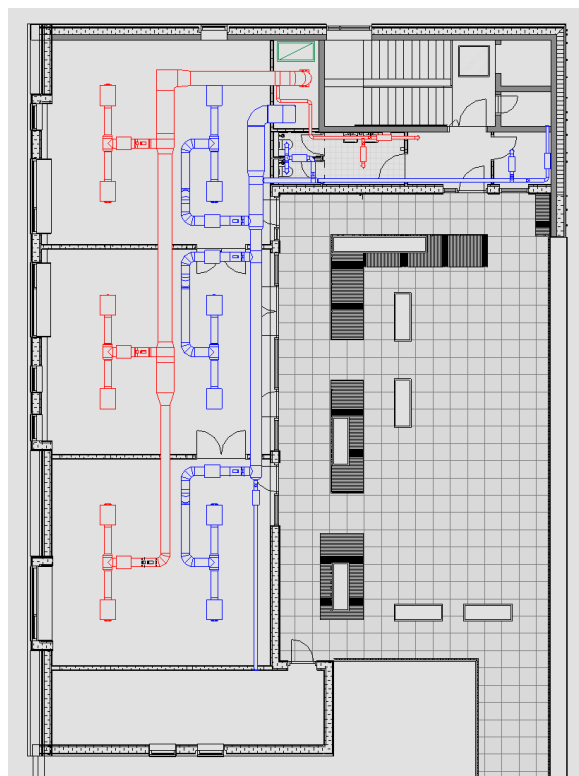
Plantegning af det modellerede ventilationssystem i stueplan.
